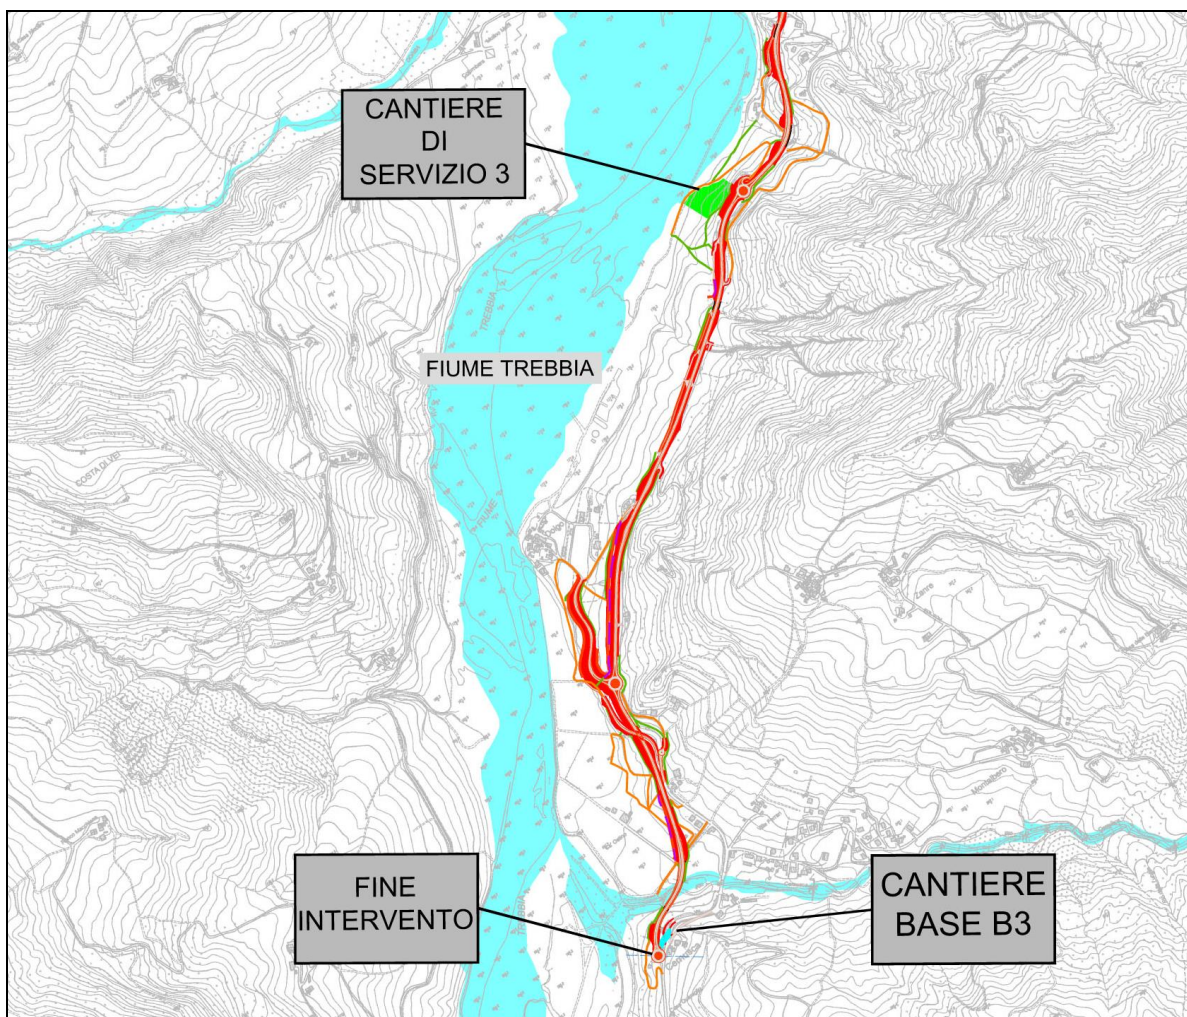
Tracciato in progetto e localizzazione delle aree di cantiere
